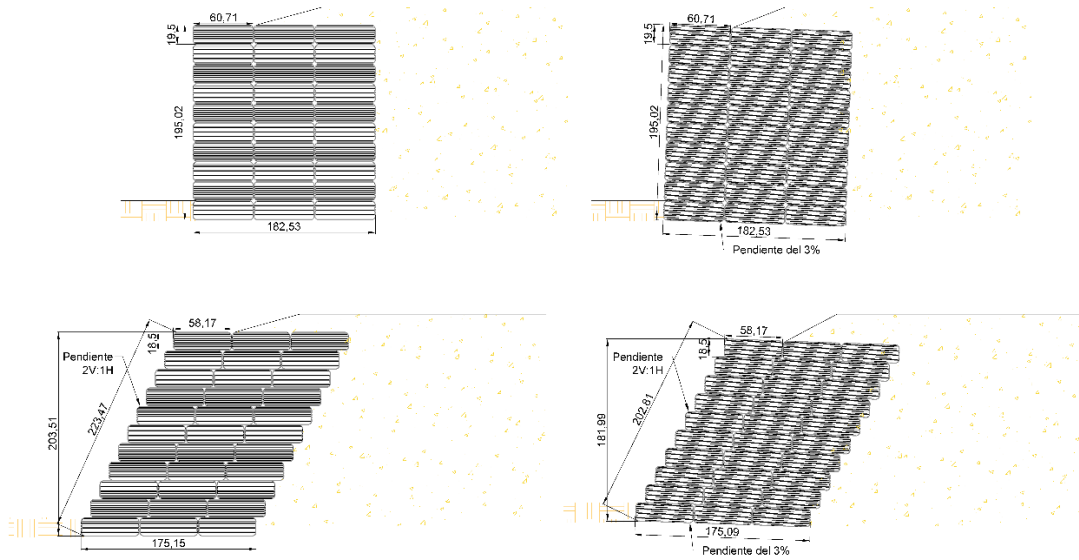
Detalles de muros con llantas de 2.0 metros de altura.
